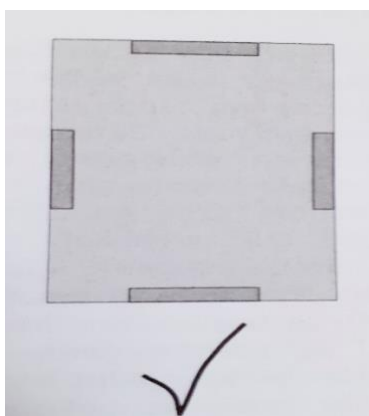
le système de contreventement doit être disposé symétriquement dans le plan du bâtiment.
